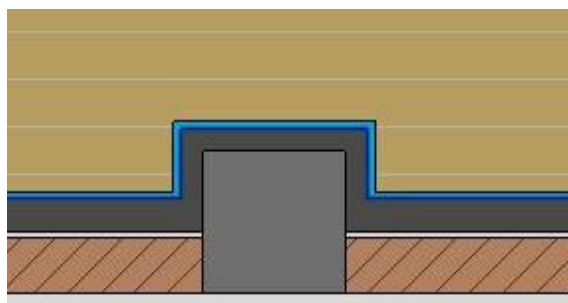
Detalle del encuentro de tabique con pilar en Revit. Fuente: Elaboración Propia
